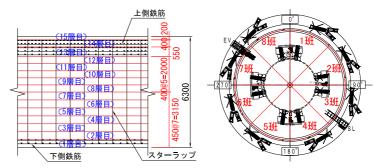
底版コンクリートの施工概要図(左:断面,右:平面)
